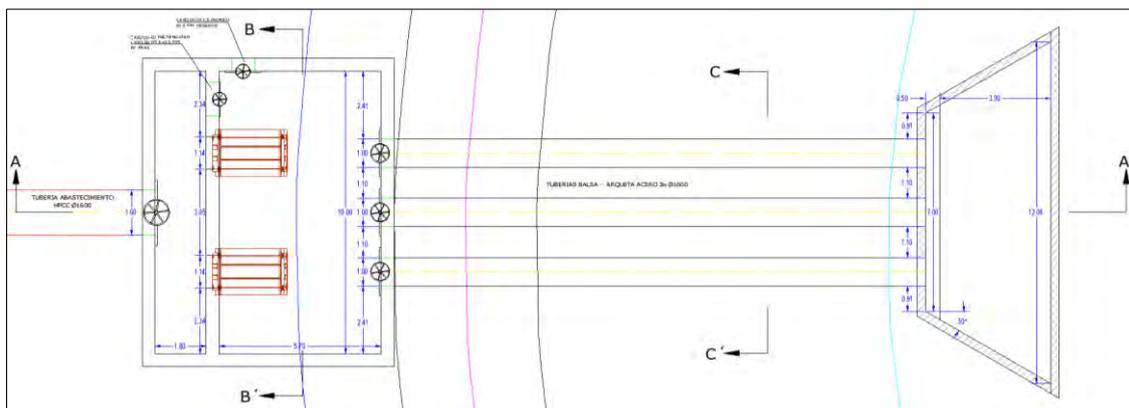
Vista en planta de la toma en balsa y arqueta de filtros del sector II.
